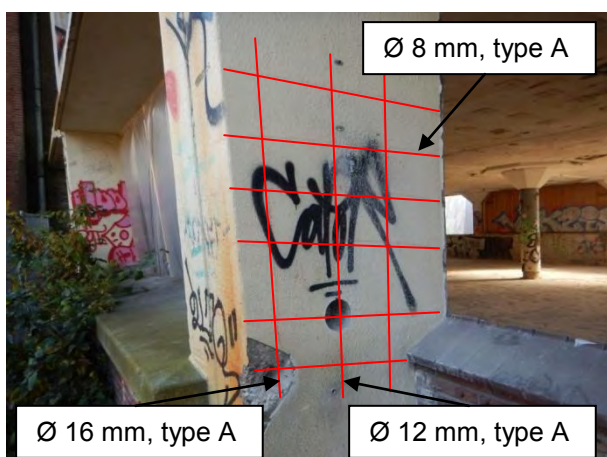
Overzicht wapeningsconfiguratie kolommen.
